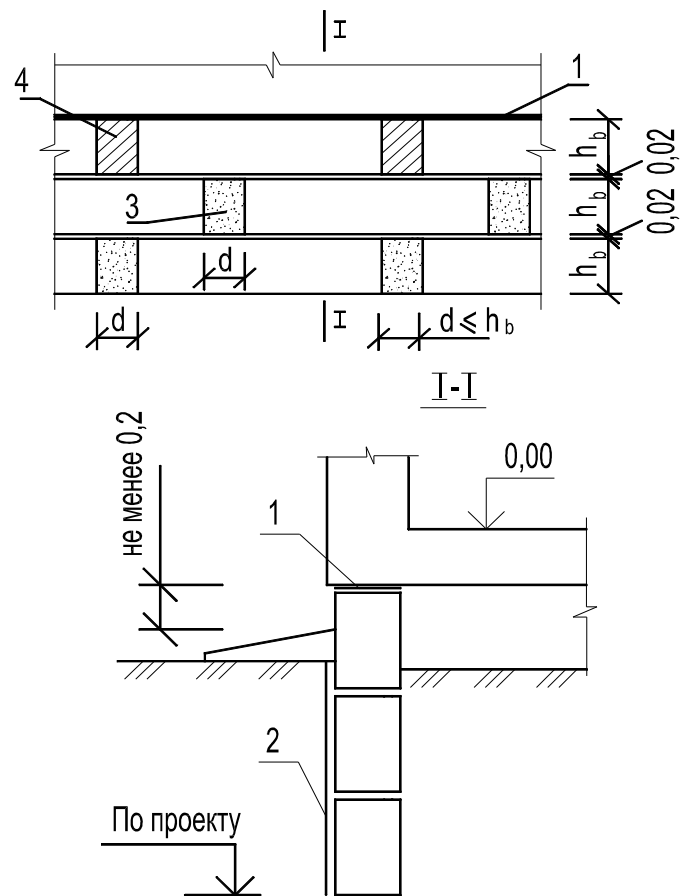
Фундаменты из сборных стеновых блоков без уширения к подошве для одно и двухэтажных зданий: 1 – два слоя рулонного материала на битумной мастике; 2 – обмазка горячим битумом за два раза; 3 – утрамбованный грунт; 4 – кирпичная кладка.
